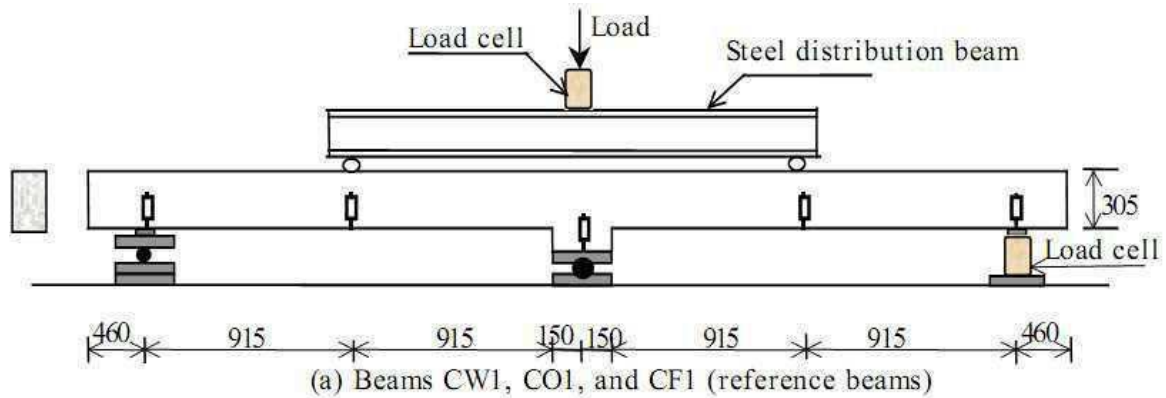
Détails de chargement des différentes poutres ; Essais Khalifa et al [89].
